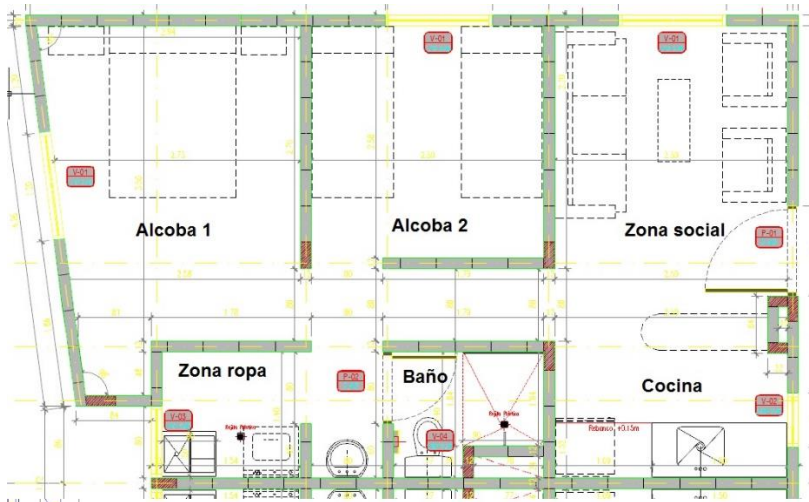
Planta típica arquitectónica A'' y B. Fuente: VIVA
